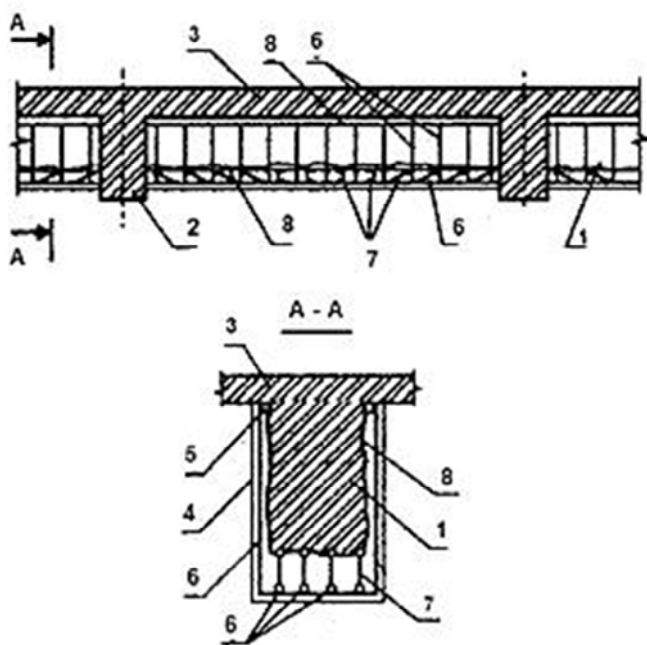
Устройство железобетонной рубашки усиления балки без вывода хомутов через плиту перекрытия:
